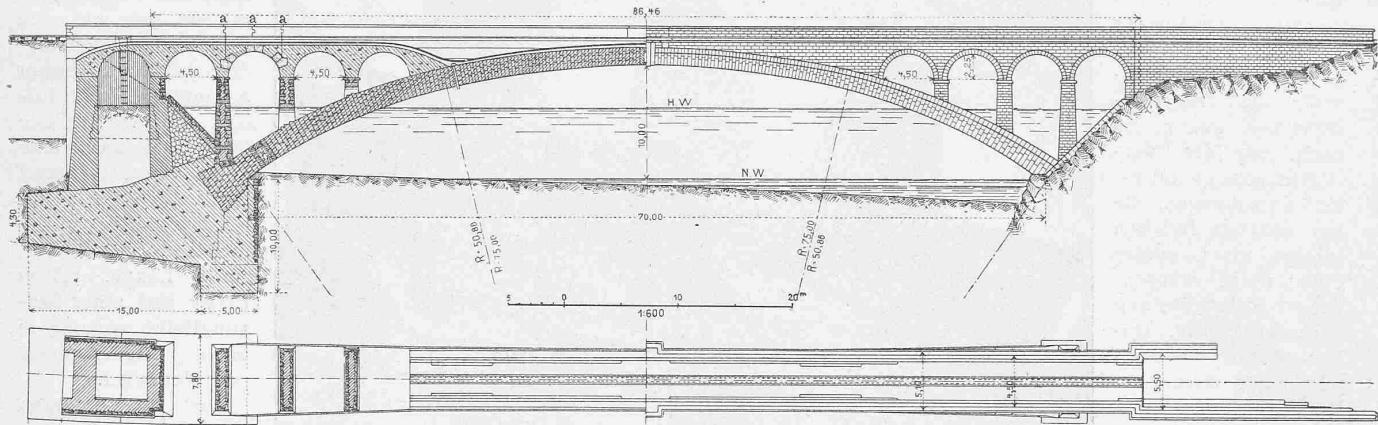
Ansicht, Längsschnitt und Grundriss. — Maßstab 1:600.
